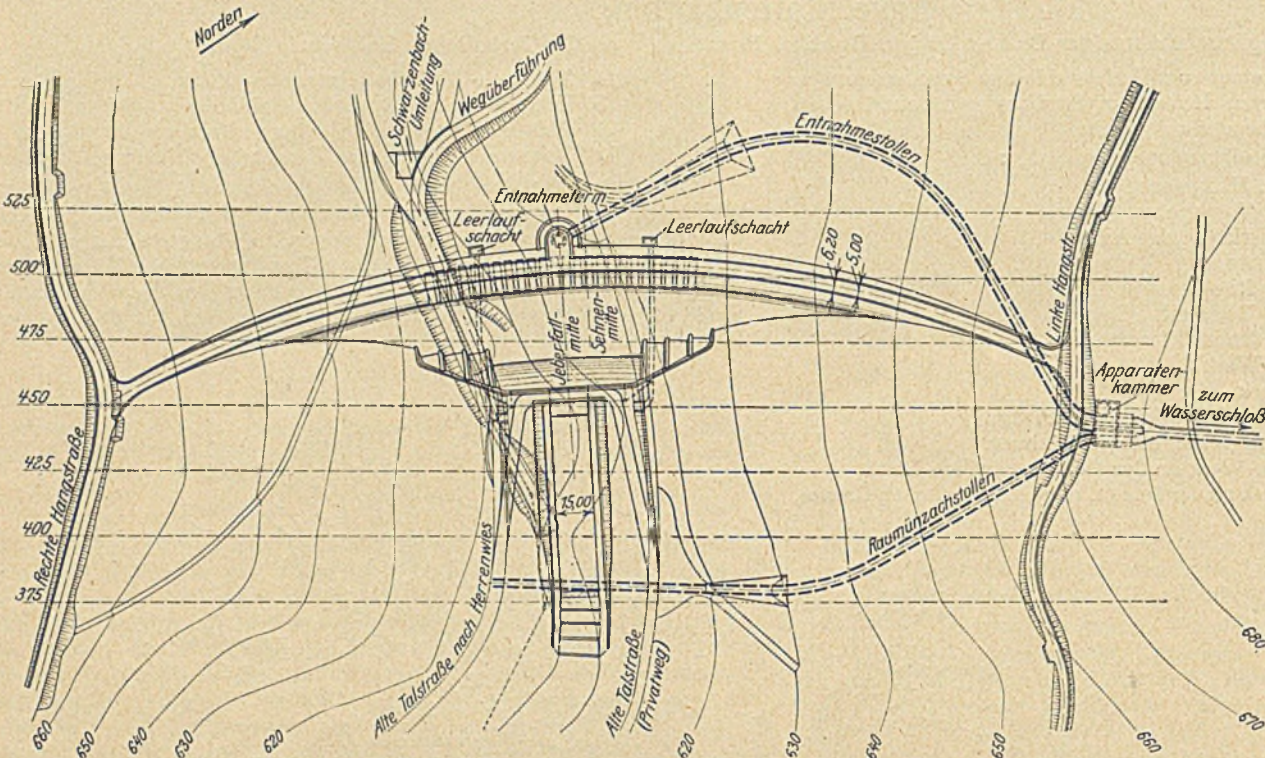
Murgwerk II. Ausbau. Staumauer mit Entnahmeturm und -stollen.
